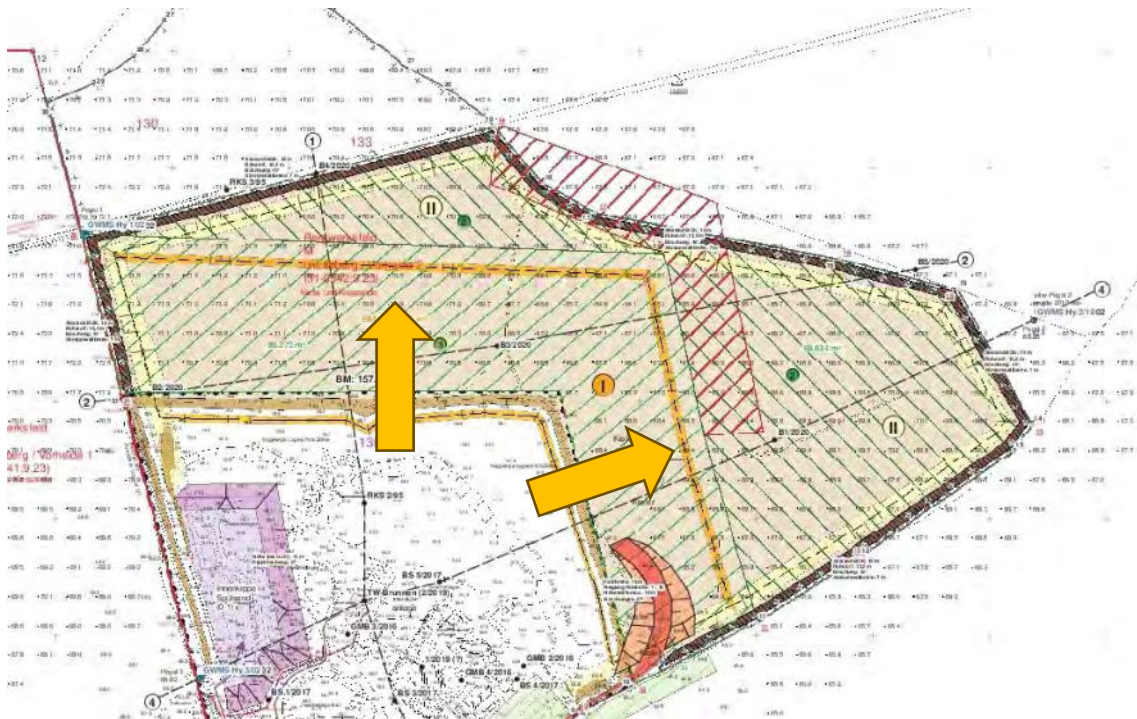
Ausschnitt aus dem Risswerk / Abbauplan (aus HBP /2.1/, Anlage 2.1)
